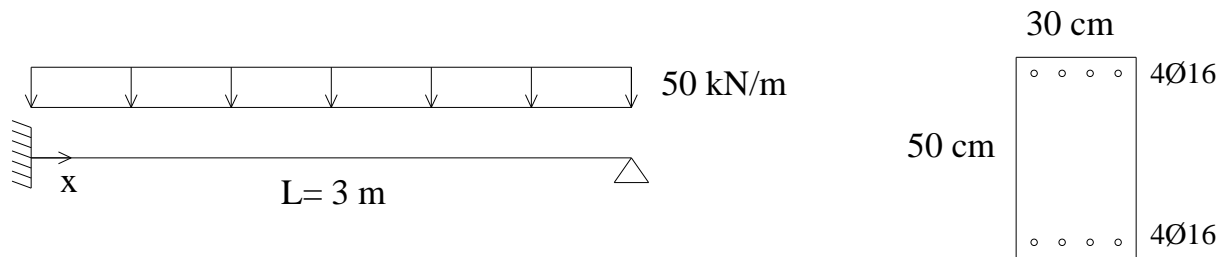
Trave iperstatica: geometria della struttura e della sezione
